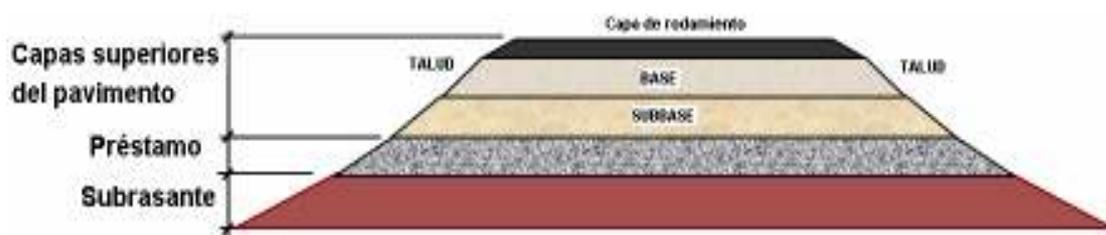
Estructura típica de un pavimento. Este proyecto incluye la colocación hasta nivel de préstamo. Las capas superiores se construirán en el futuro por medio de una nueva licitación.
